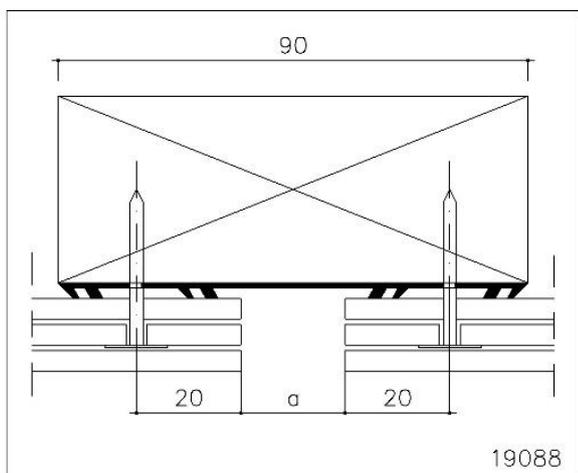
joint de 90 mm en EPDM derrière le joint ouvert
